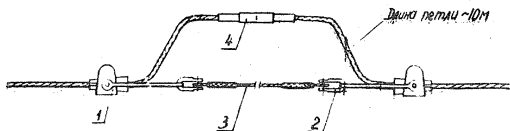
Опрессовка проводов соединительными зажимами при раскатке.
